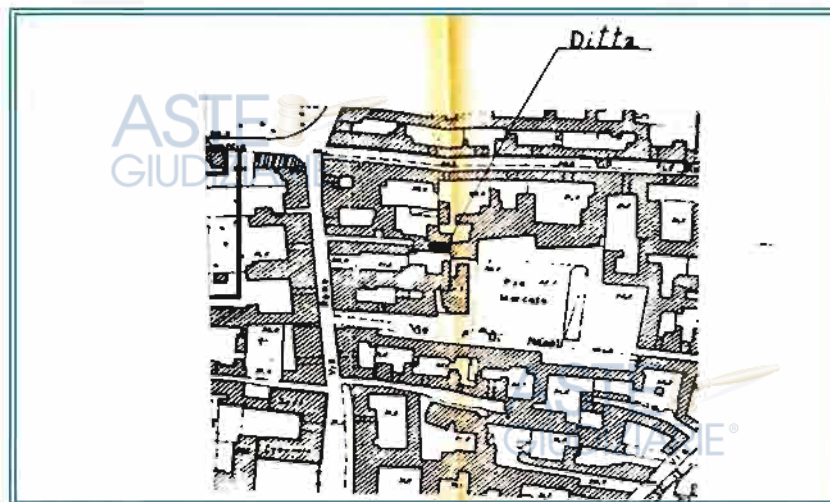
Planimetria inquadramento – estratto dal fascicolo pratica di costruzione edile n. 5951 del 17.03.1988
